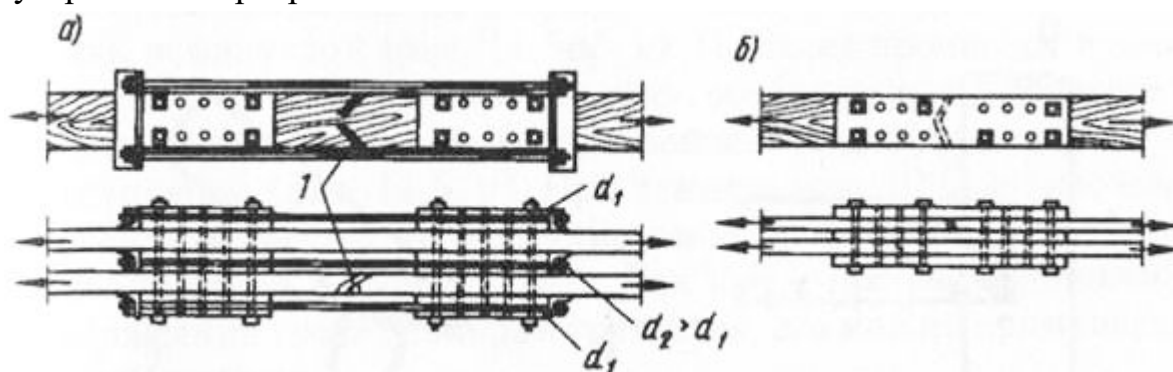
Усиление растянутого пояса ферм а — при помощи тяжей из круглой стали с постановкой дополнительных досок на болтах; б — при помощи деревянных накладок на болтах
